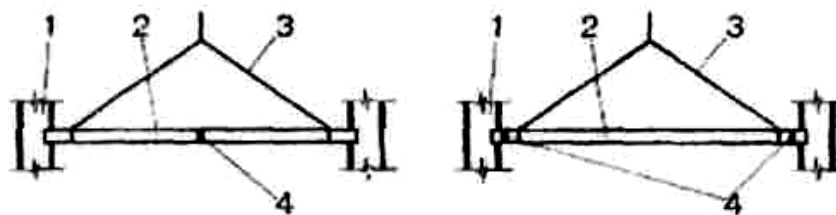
Схеми розбирання дерев'яних балок перекриттів: а – пропили по середині; б – пропили по краях; 1 – існуючі стіни; 2 – балка, що розбирається; 3 – стропи; 4 – пропили
